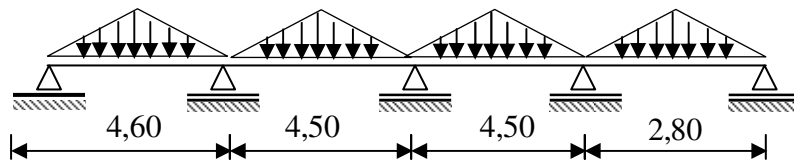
Distribution des charges sur les poutres aux sens secondaires
